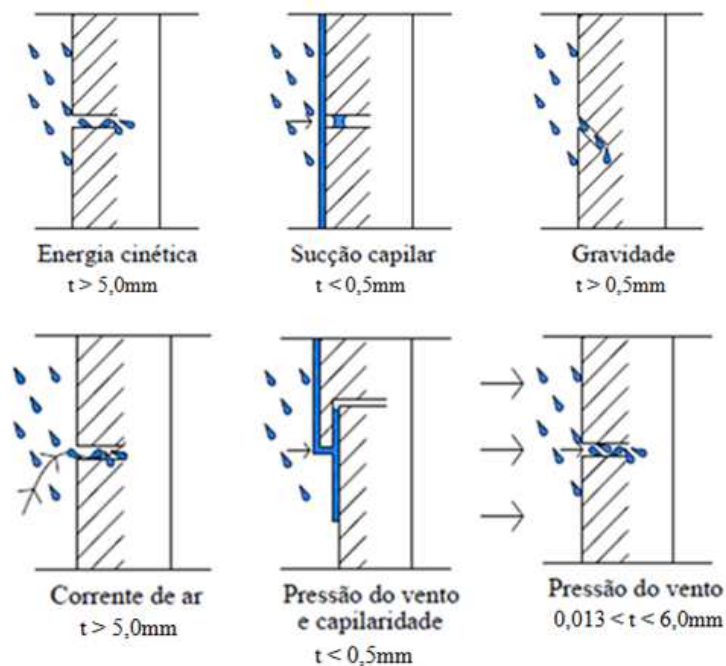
forças produzindo penetração da chuva (adaptado de BAUER, 1987; MELO JR., 2010)
